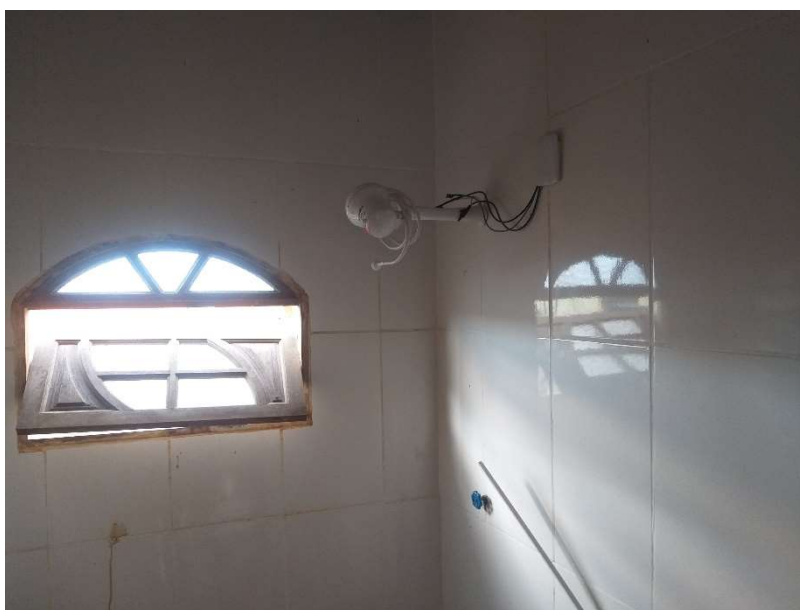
INSTALAÇÃO DE CHUVEIRO NO BANHEIRO
